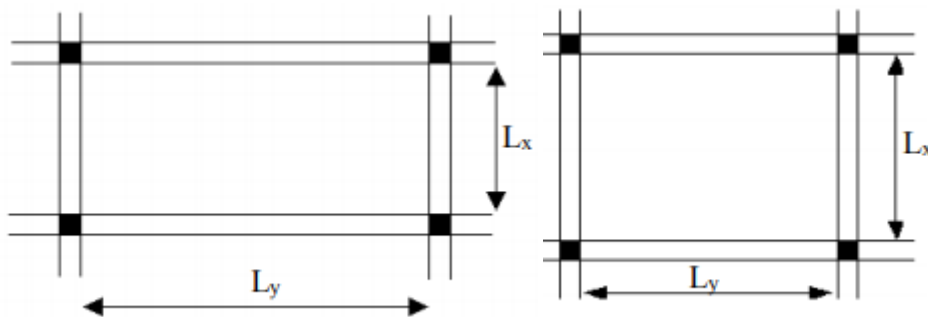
Dimensions d'un panneau de dalle pleine.
